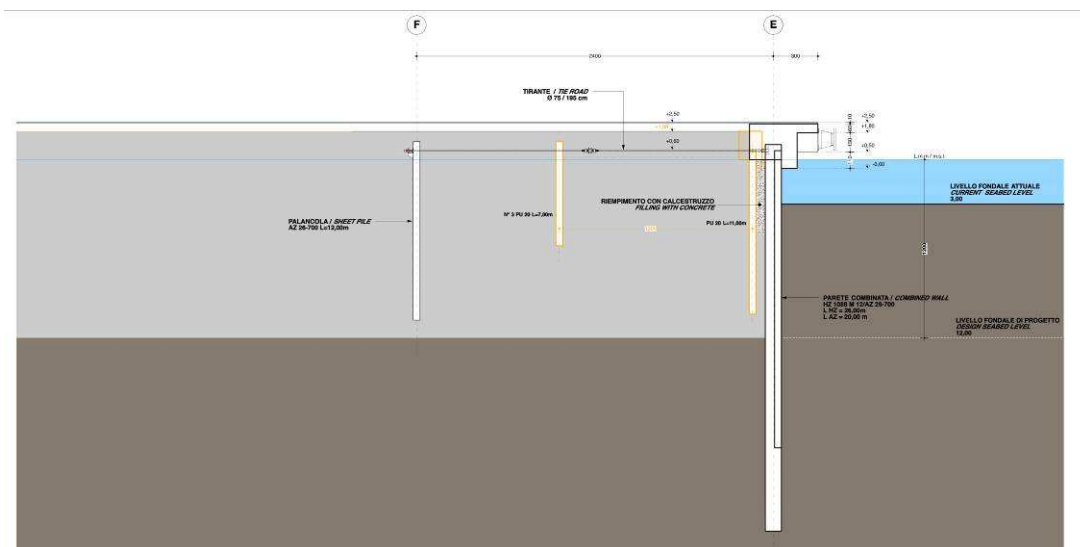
sezione banchina esistente con soluzione di progetto
